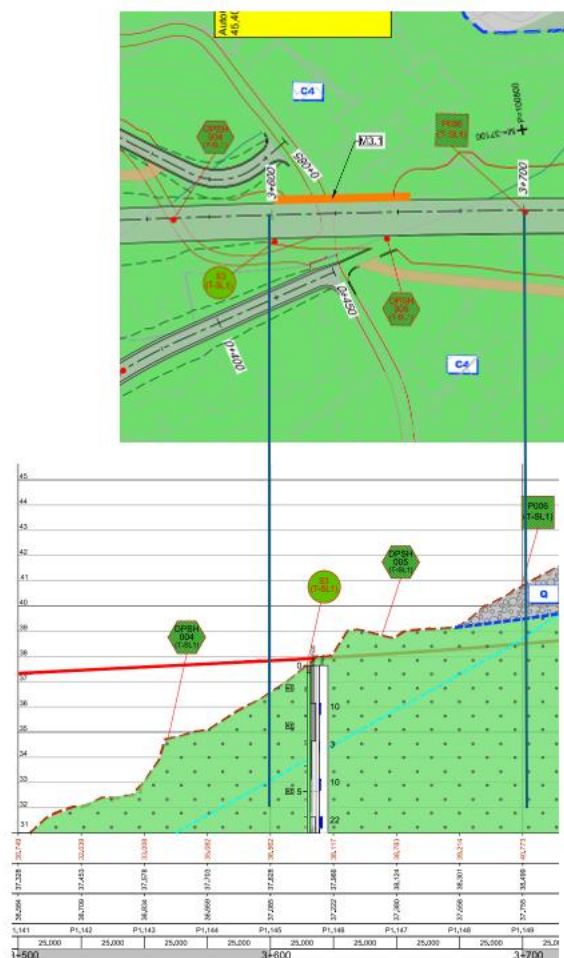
Muro M3.1. Planta e corte geotécnico. Extrato do Des. PF102A1.PR.01.07.00.00.106.00
